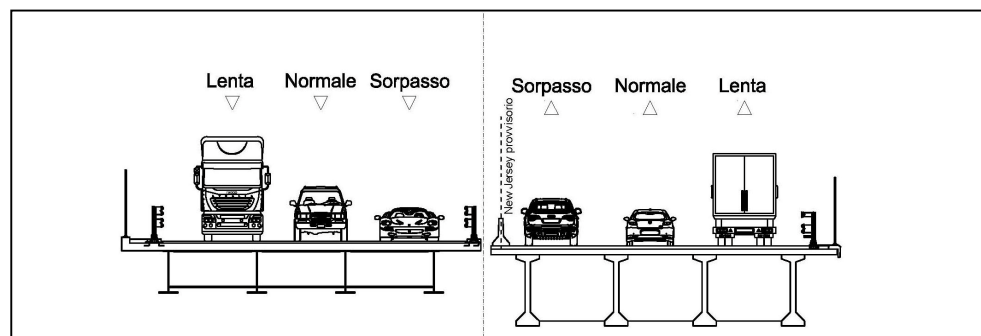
Cantierizzazione n. 3 - tratto 1 finito
